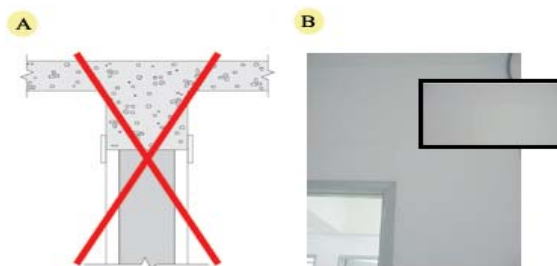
Modo não recomendável de executar encontro entre parede *dry-wall* e fundo de viga, emenda com paredes e/ou pilares
